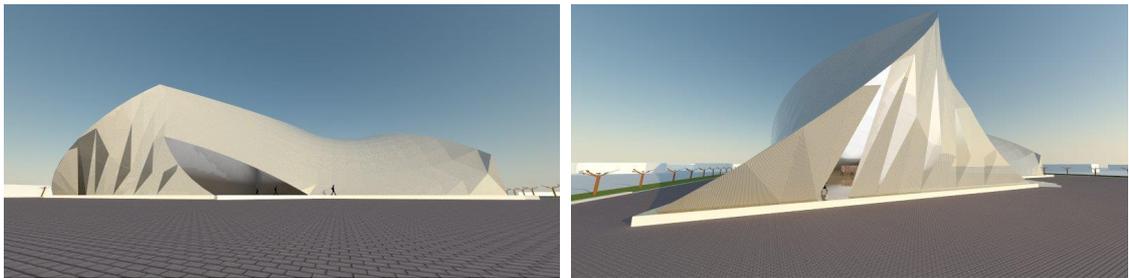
Gambar Ilustrasi struktur beton dan core bangunan Galeri Seni Mural di Kota Balikpapan
